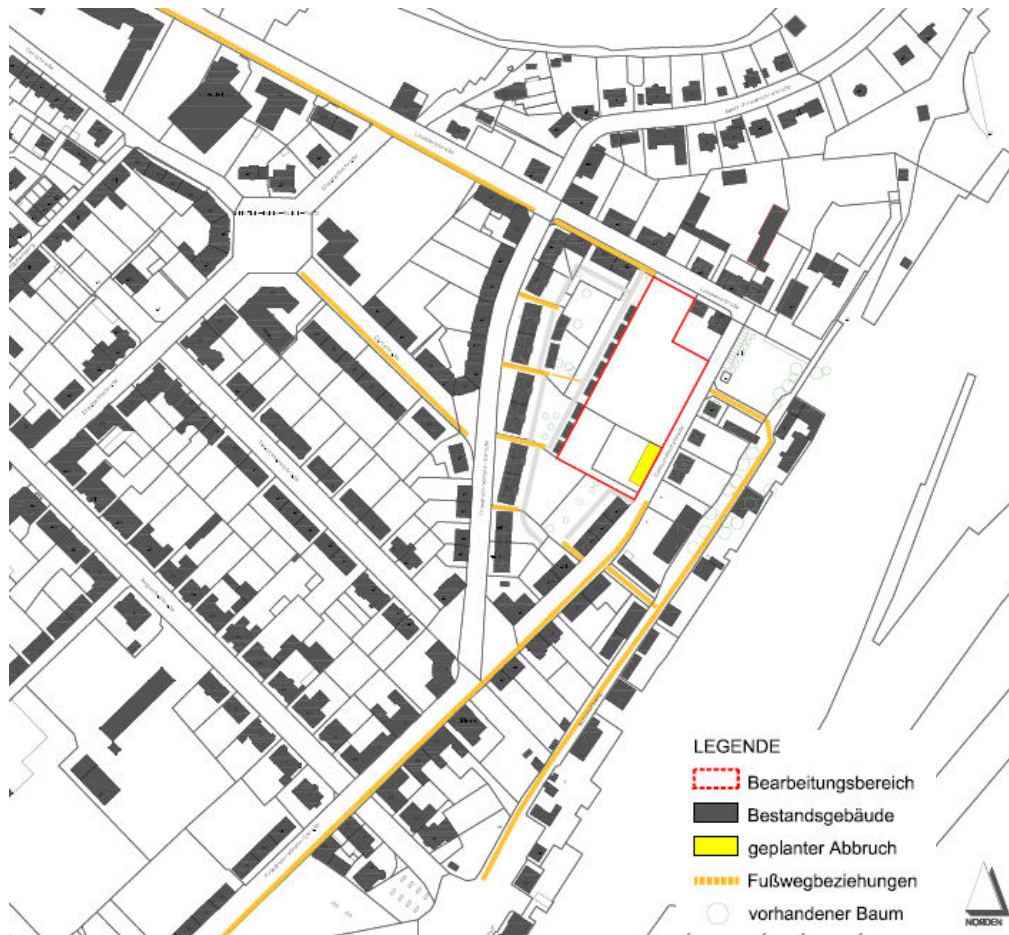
Lage des Projektstandortes und Umgebungsbebauung
